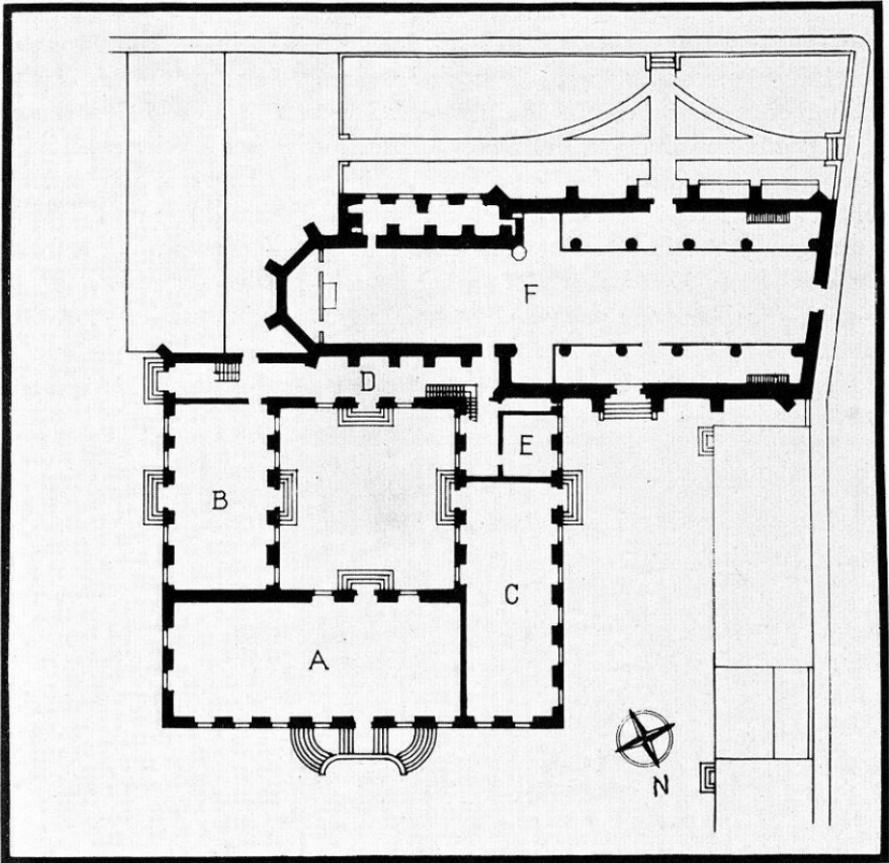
Erdgeschoß des Kollegienhauses im Jahre 1748
